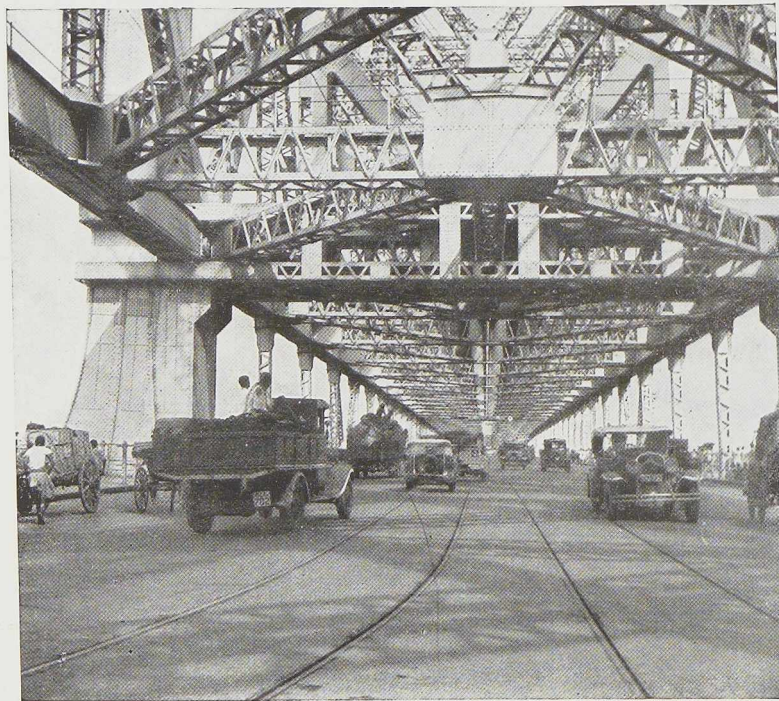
Vue d'enfilade du tablier suspendu du nouveau pont de Howrah. On voit au-dessus de la chaussée les membrures inférieures et le contreventement horizontal des maîtresses-poutres.
